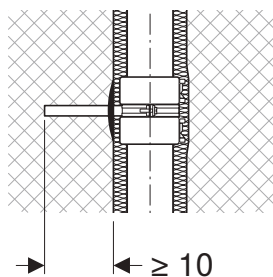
Pevný bod pomocí spojovacího pouzdra u zabetonovaných, neizolovaných přímých průstupů stropem
